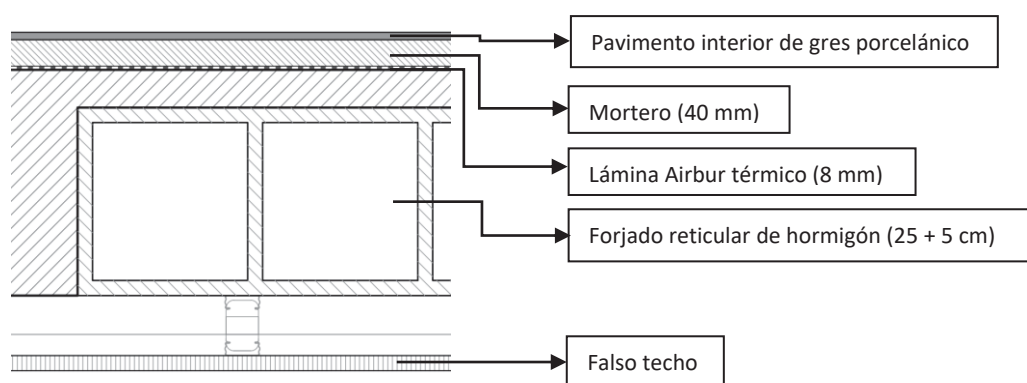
Esquema del elemento separador horizontal de la primera planta original del edificio.
